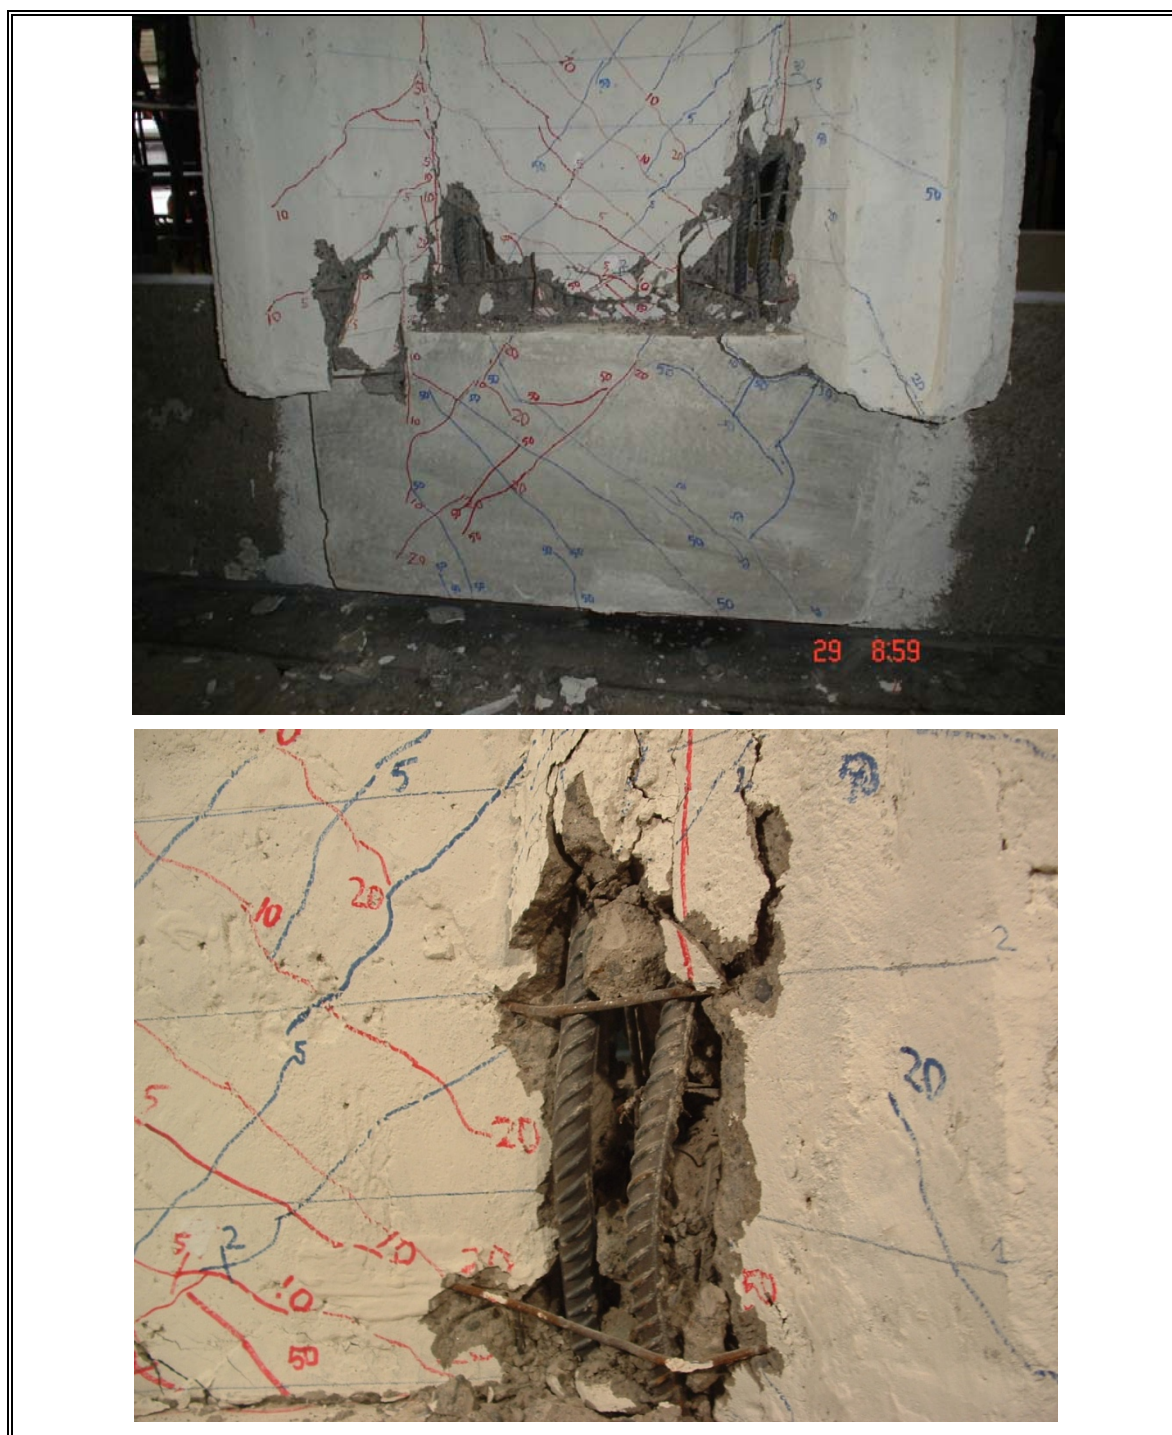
Tipo de falla de los ensayos cíclicos del nudo Dalla-Viga I-130 y evidencia del pandeo de las barras de las horquillas de anclaje.
